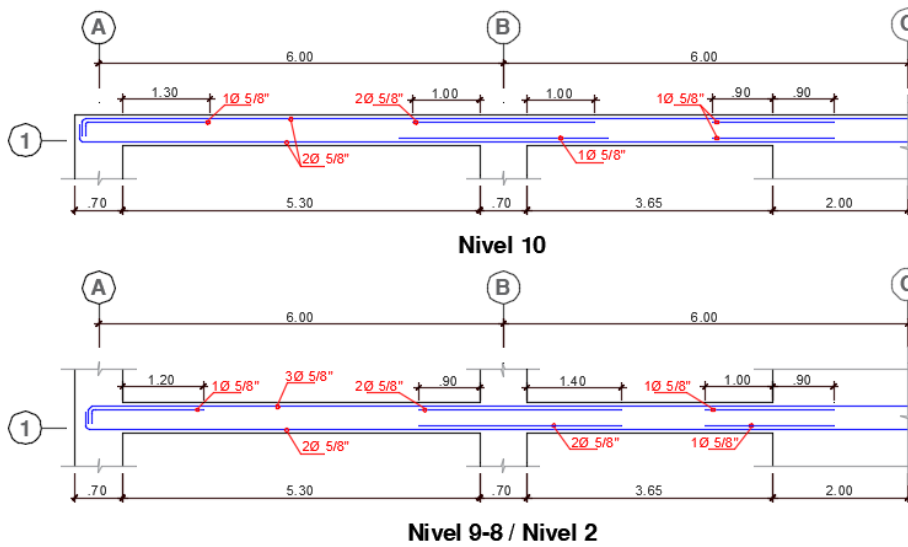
Refuerzo requerido por flexo-tracción en las vigas para el edificio Edi-10
